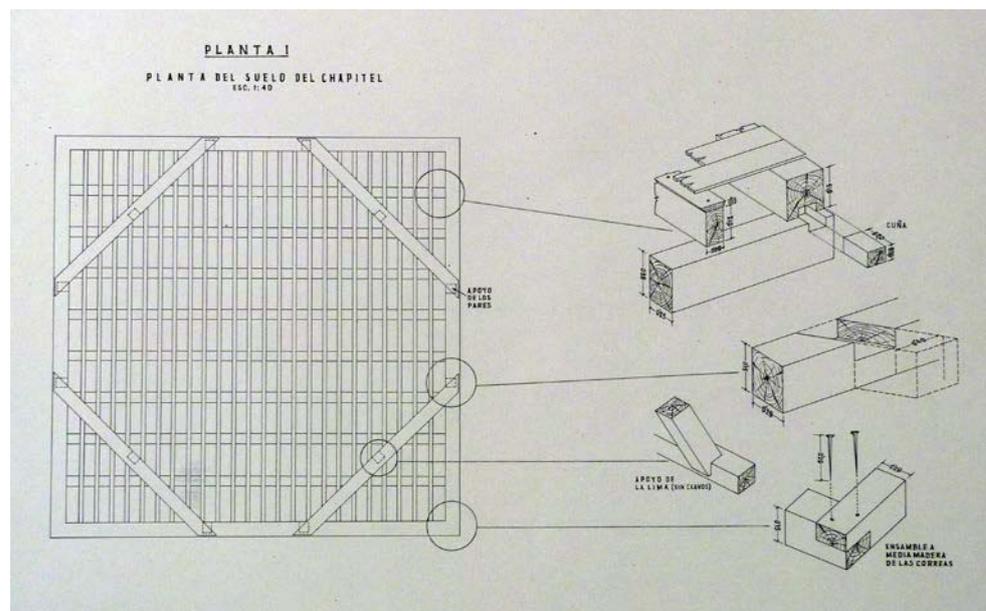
Planta y detalles de la misma, según Julio Vidaurre. A.D.A.P.N. Plano 421
